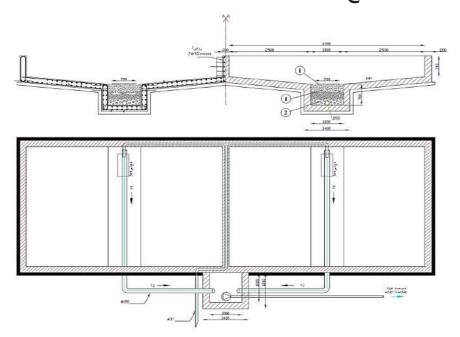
يوضح مسقط و مقطع حوض تجفيف حمأة رملي نموذجي
